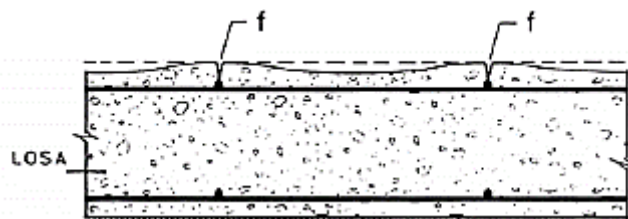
Grietas por asentamiento plástico del concreto fresco.
